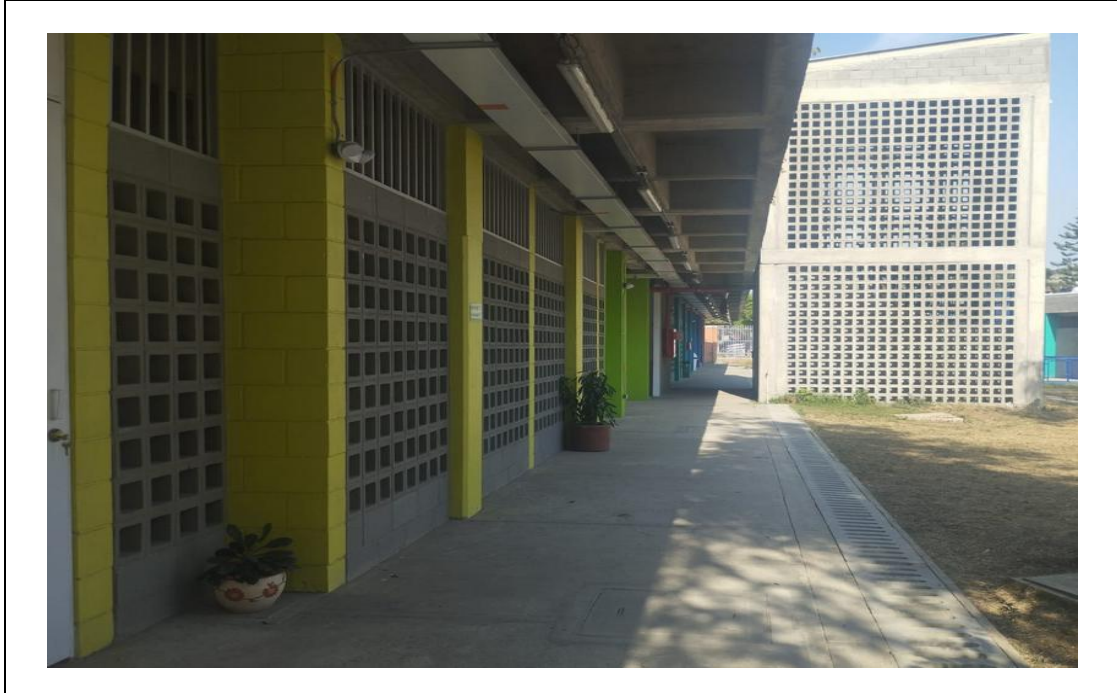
Andenes en concreto con cárcamo de confinamiento.
